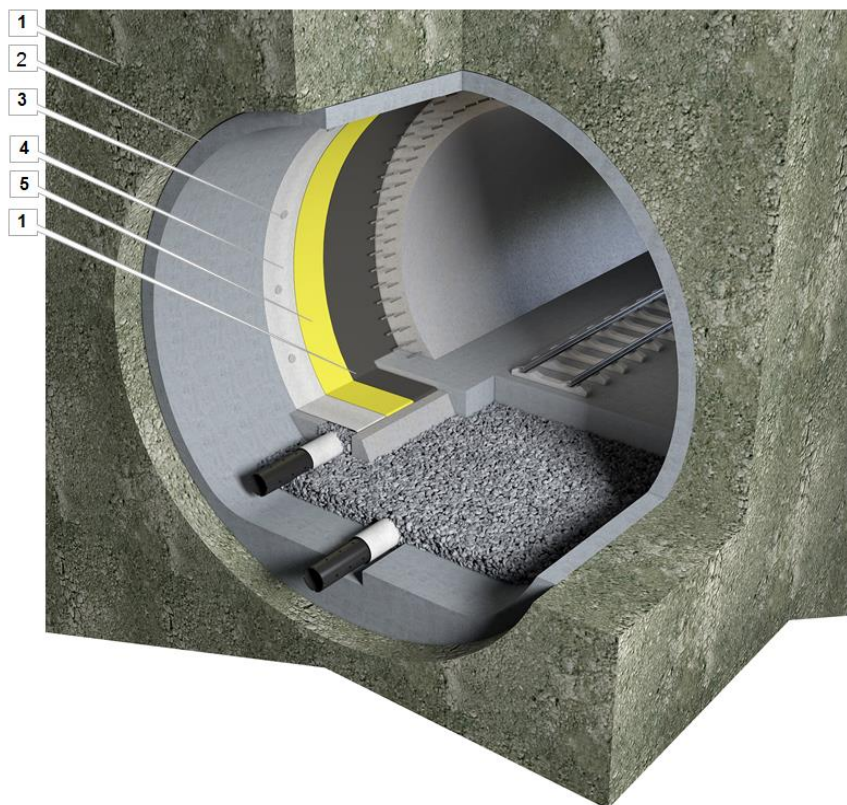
Конструкция гидроизоляционного покрытия транспортных тоннелей, сооружаемых закрытым способом (метод НАТМ).
